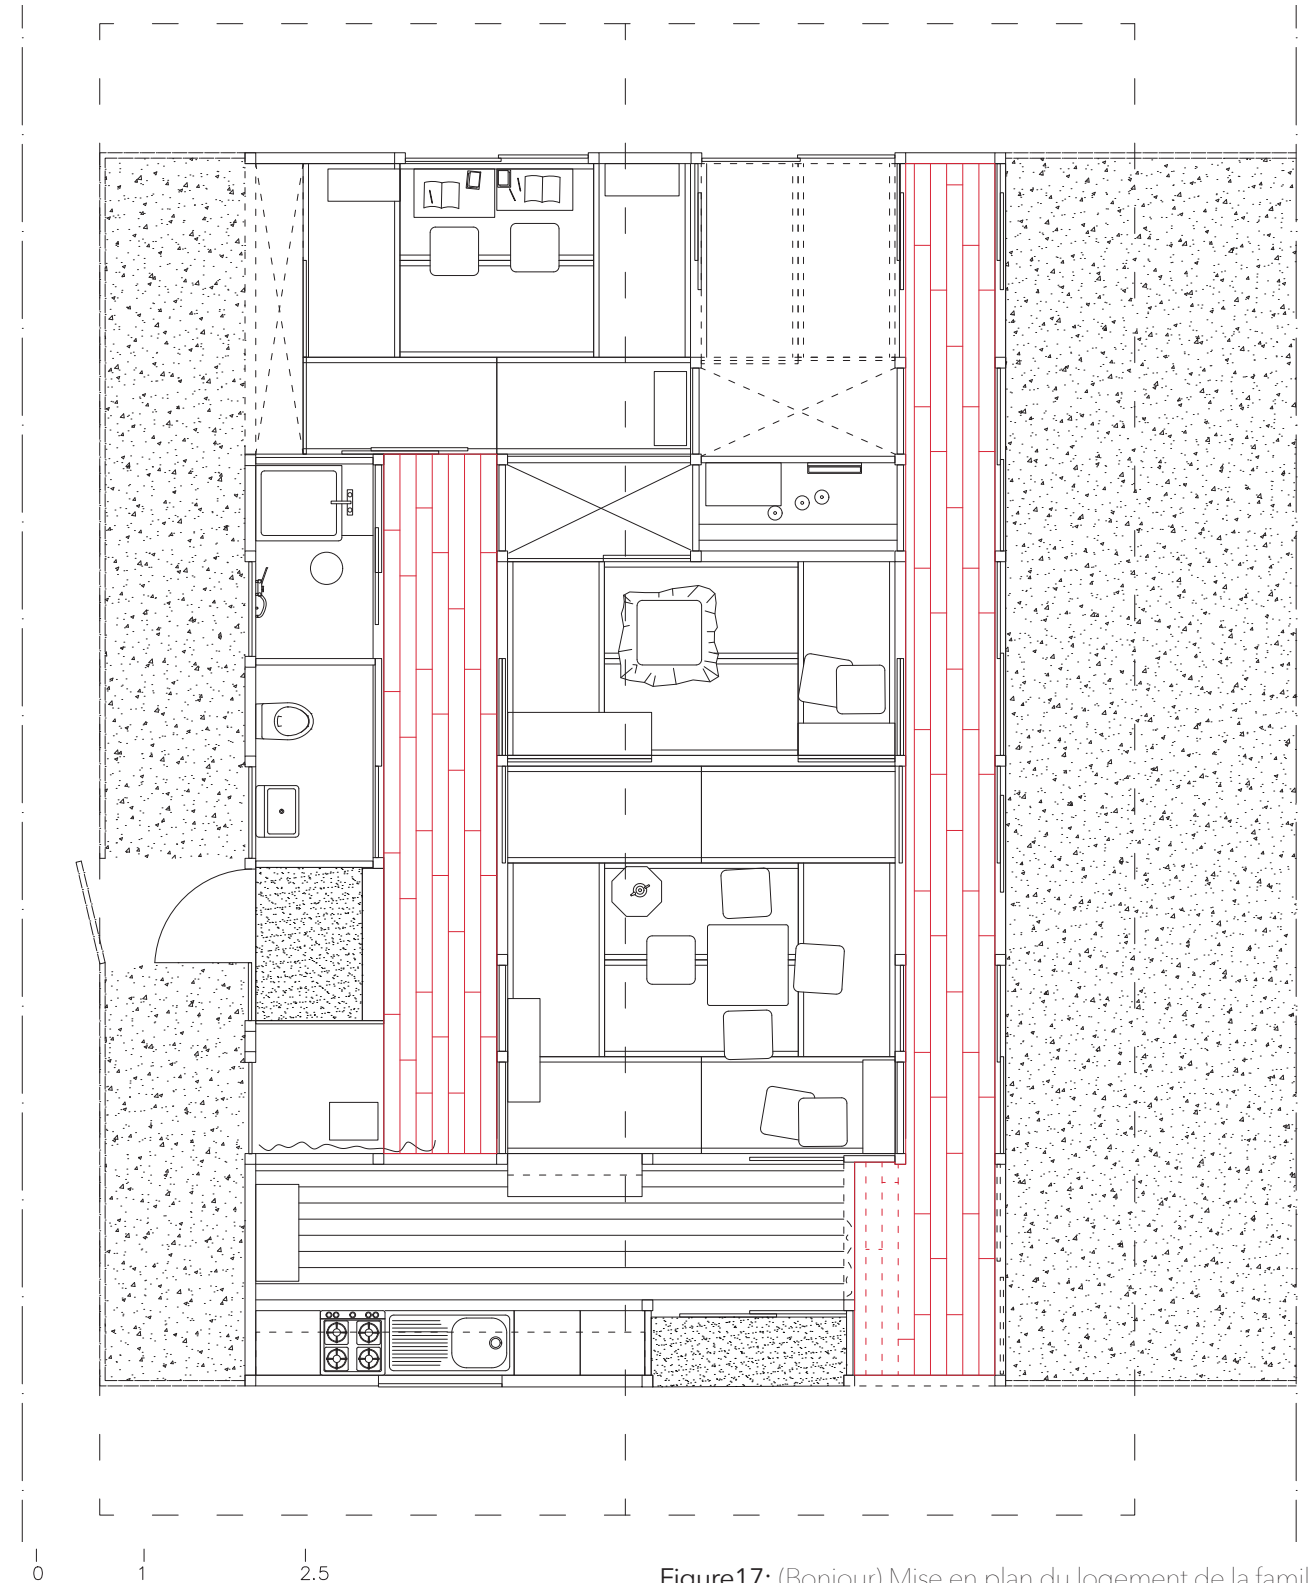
(Bonjour) Mise en plan du logement de la famille Hayashi
